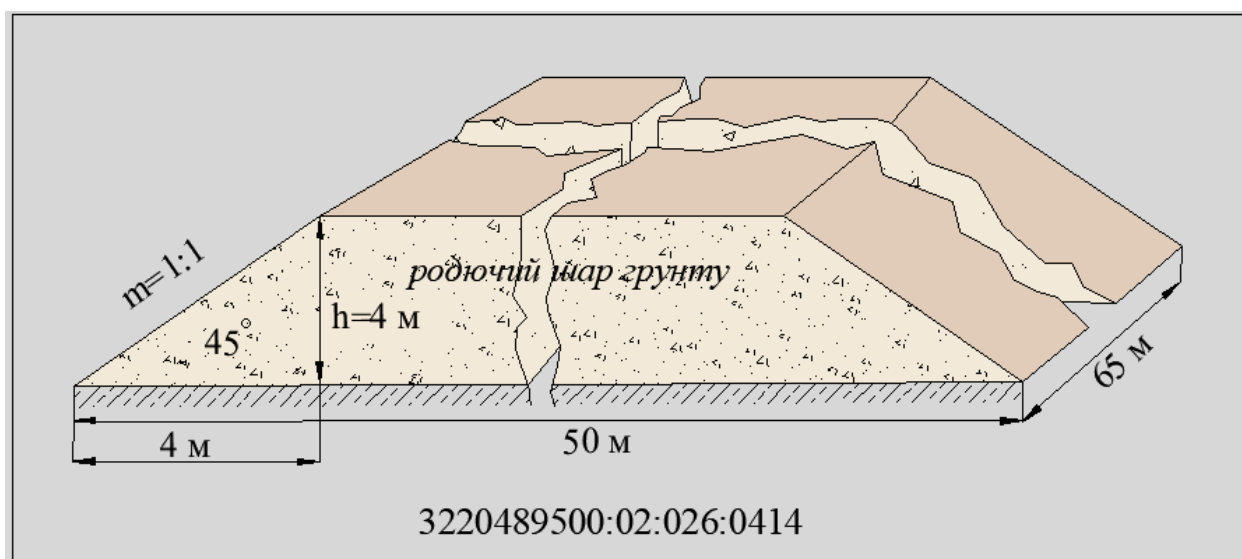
Схема поперечного перерізу тимчасового відвалу № 1 (розроблено здобувачем)
